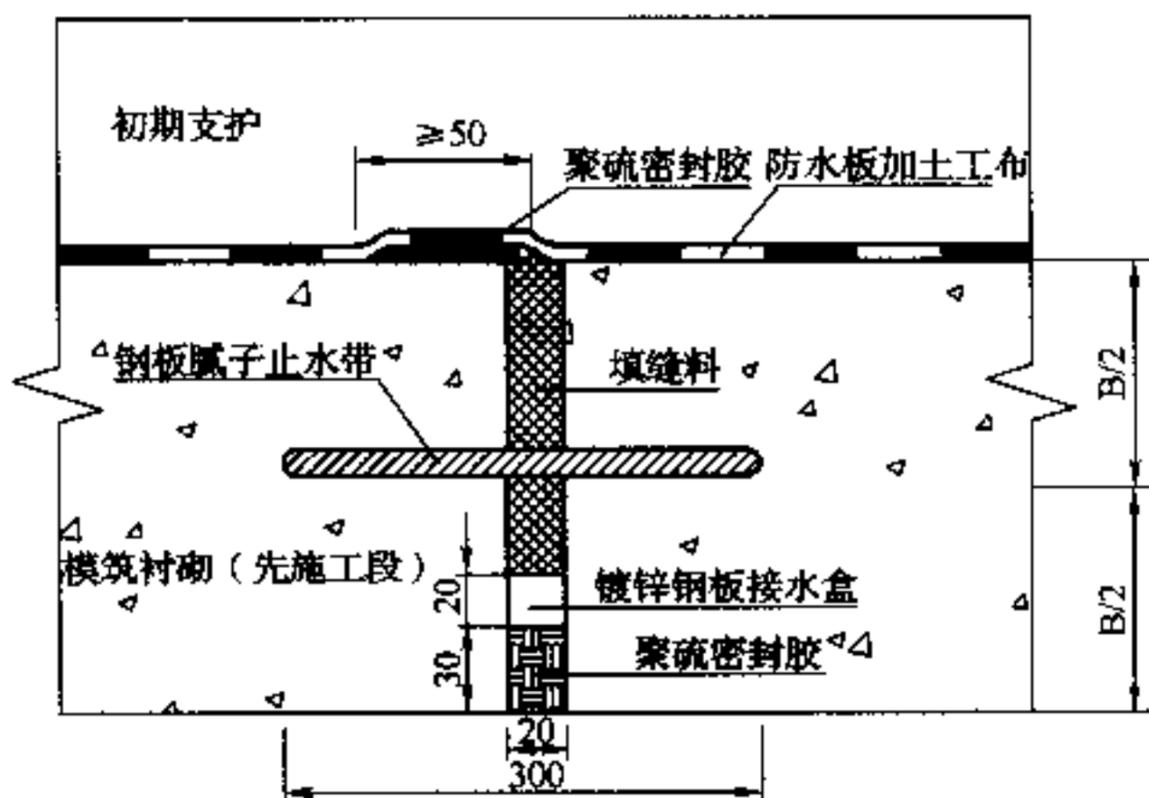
5 带接水盒的变形缝构造形式 (单位: mm)
